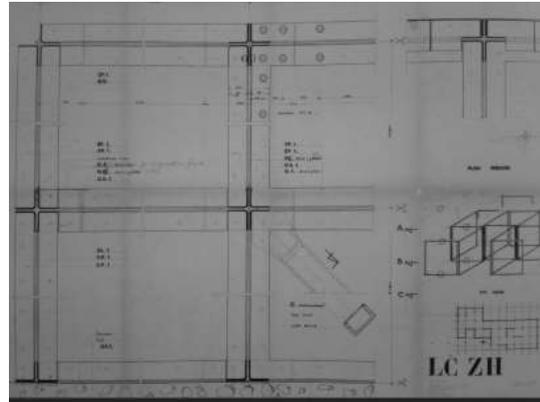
Planos de montaje de Le Brevet. Louis Fruitet 226x226x226, mayo , 1966.
